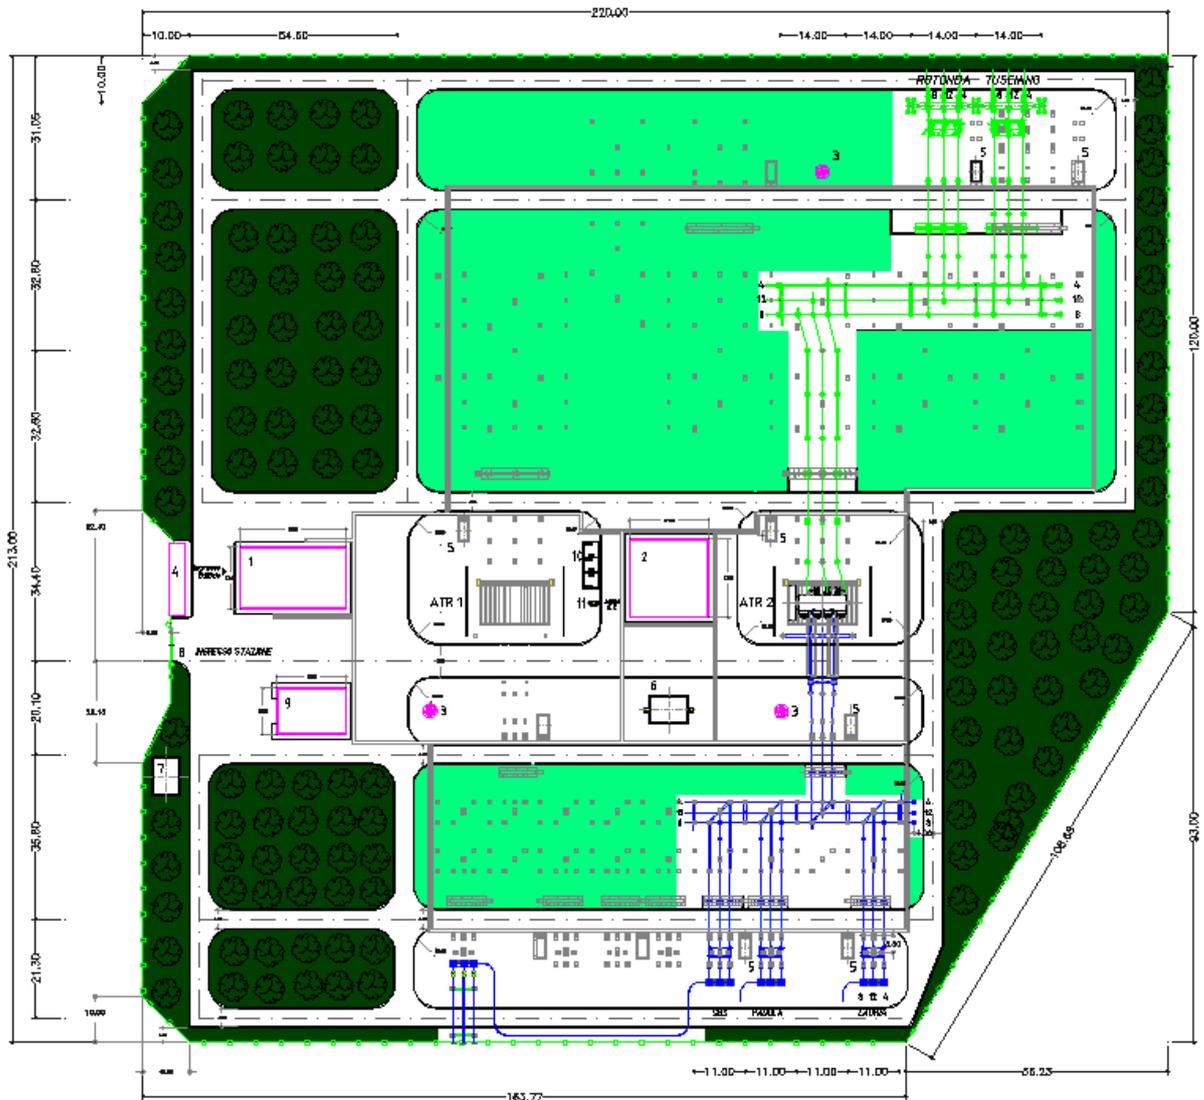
Planimetria elettromeccanica generale – prima ipotesi alternativa
